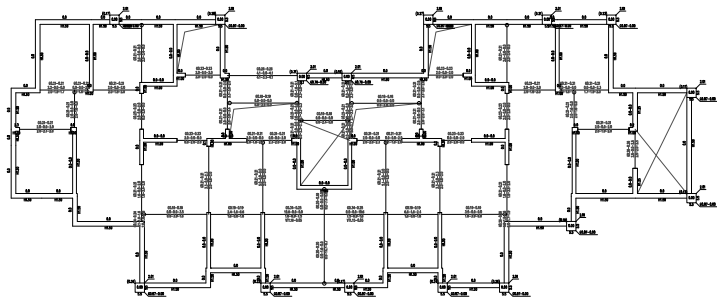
某办公楼 裙7层 地上标准层结构平面布置图(单位:mm)
